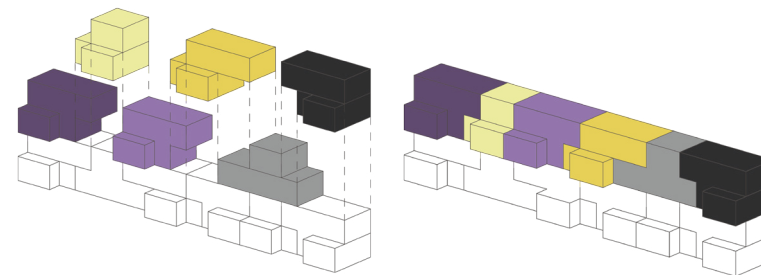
Esquema construcción de la torre a partir de los módulos tipo lego.
